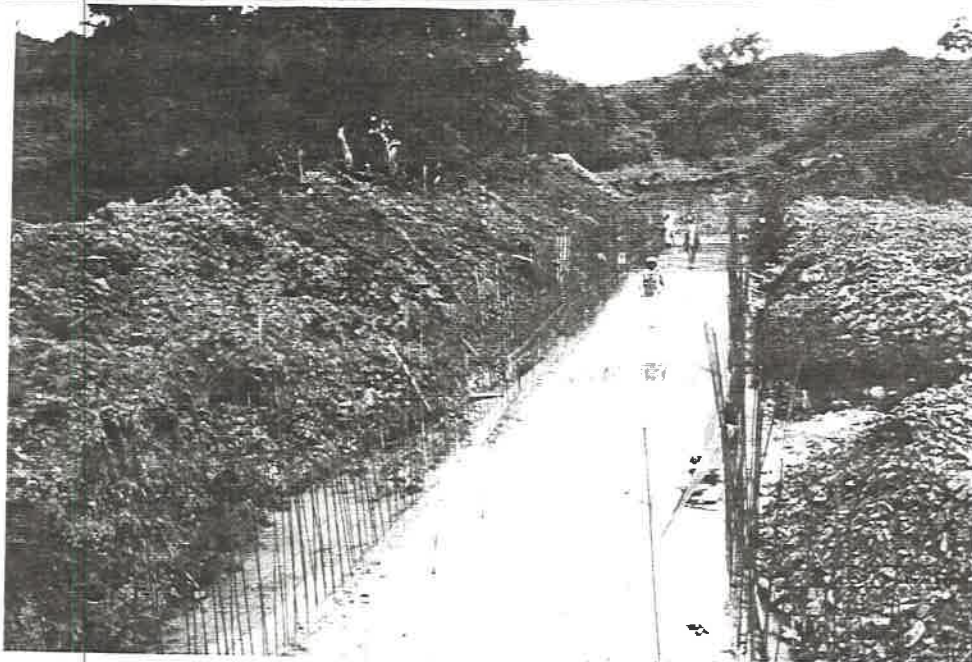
Base de concreto reforzado y colocación de acero de refuerzo de alcantarilla de cajón ubicada en el área de cuarto de milla. Se conecta con el Canal No.1A.
